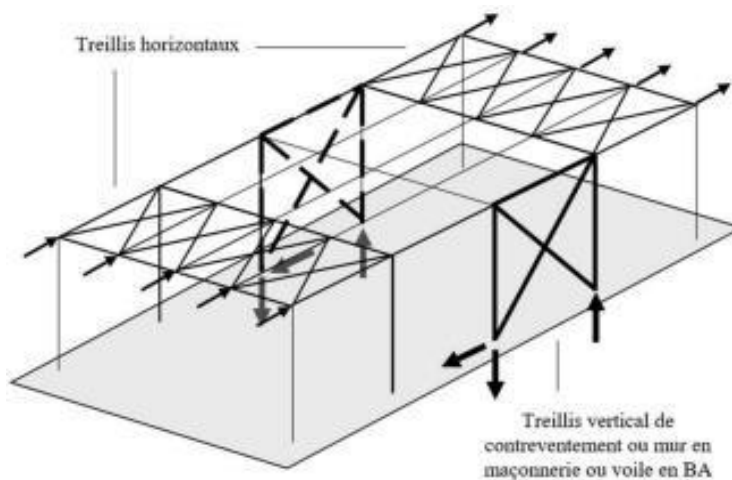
Stabilisation longitudinale d'un bâtiment industriel par contreventement
